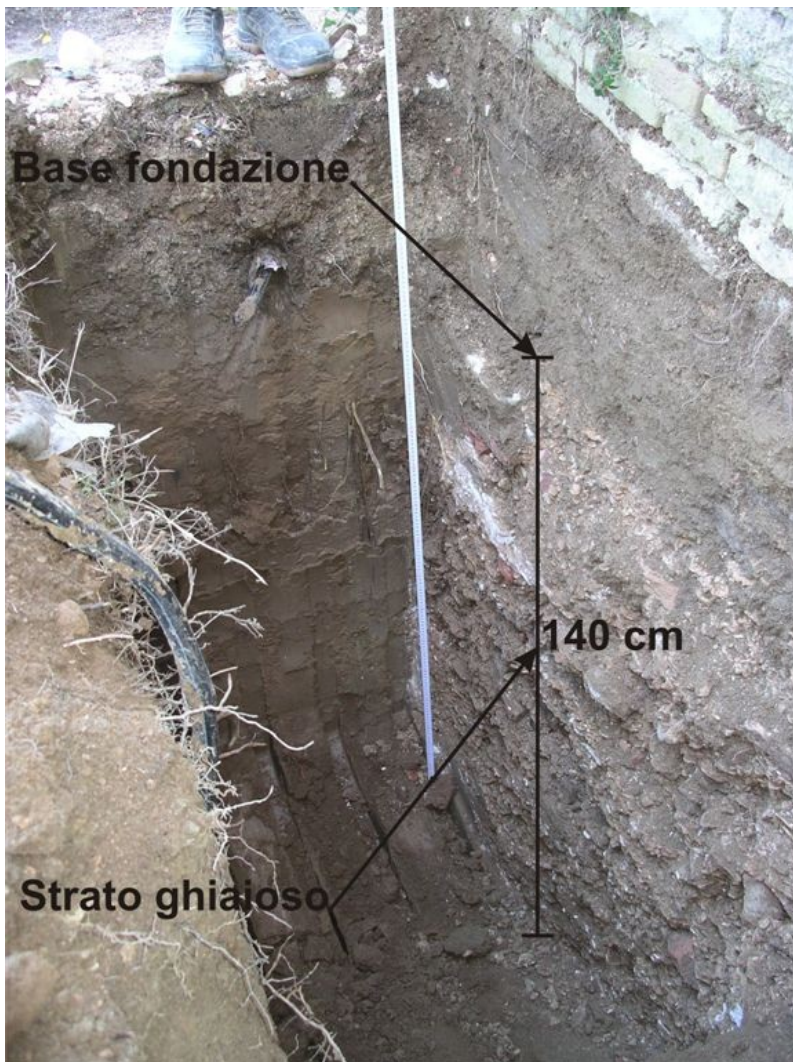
Scavo profondo 1,9 m. La fondazione dell'edificio risulta posata a -50 cm e formata da pietre squadrate ben connesse; da tale quota sino a fondo scavo (ed oltre) si rileva, sotto la fondazione, una sorta di magrone, costituito da ghiaia non cementata. Il substrato litoide non è stato intercettato.
